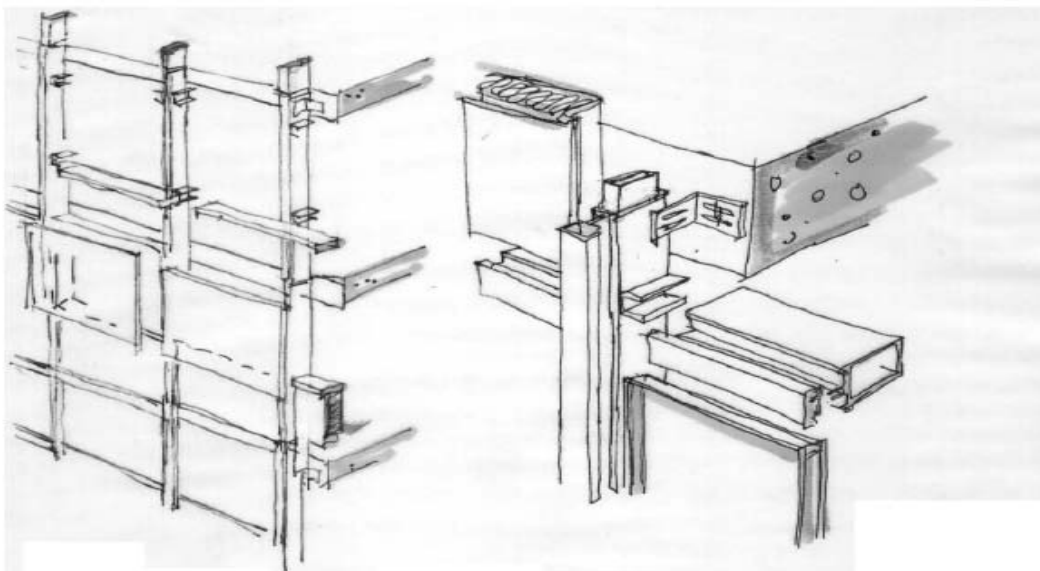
Imagen que muestra detalles de fachada ligera construida mediante el sistema Stick.
